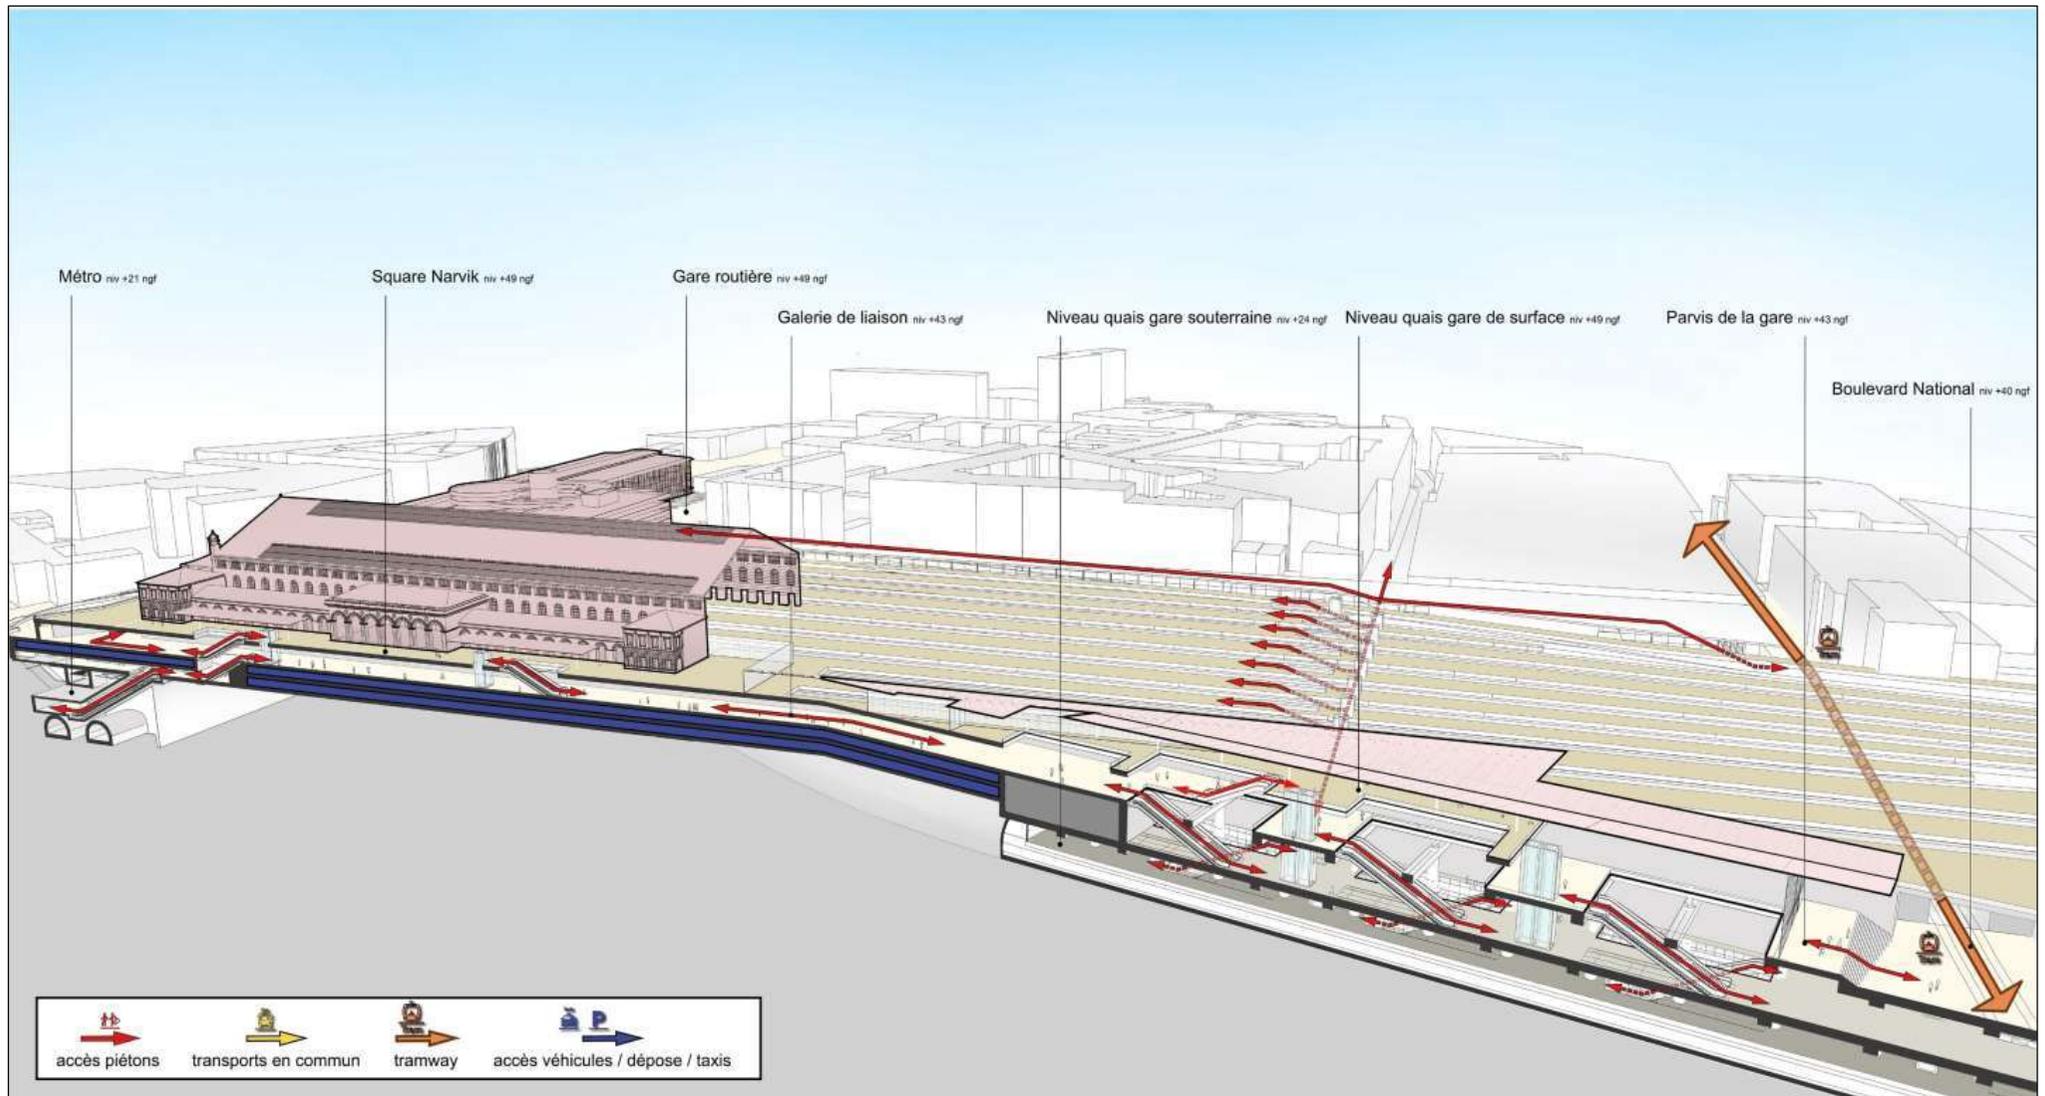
Coupe longitudinale sur le site de St-Charles - principe des échanges internes gare
